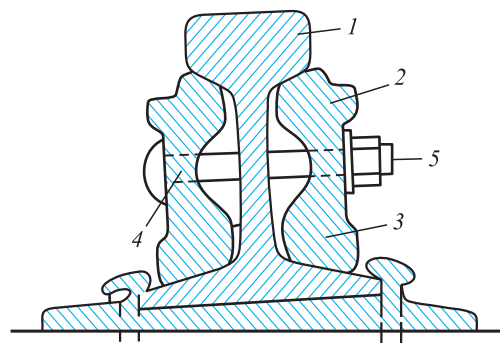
Стандартный рельсовый стык с накладками Р65:
